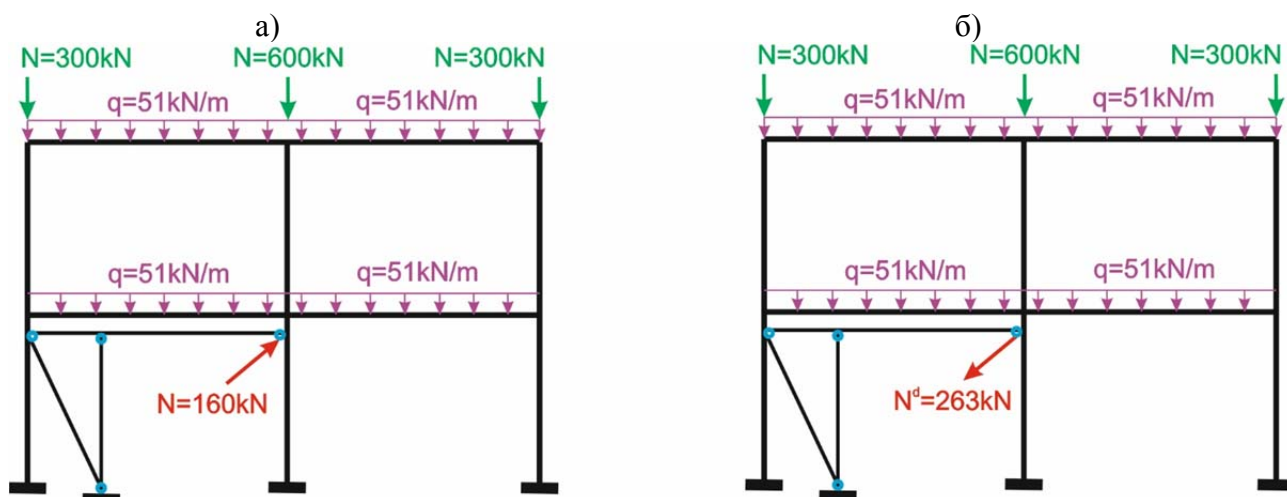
Вторичная расчетная схема железобетонной рамы для анализа сопротивления прогрессирующему обрушению: а) на этапе первых разрушений; б) на этапе максимального динамического догружения вторичной расчетной схемы
